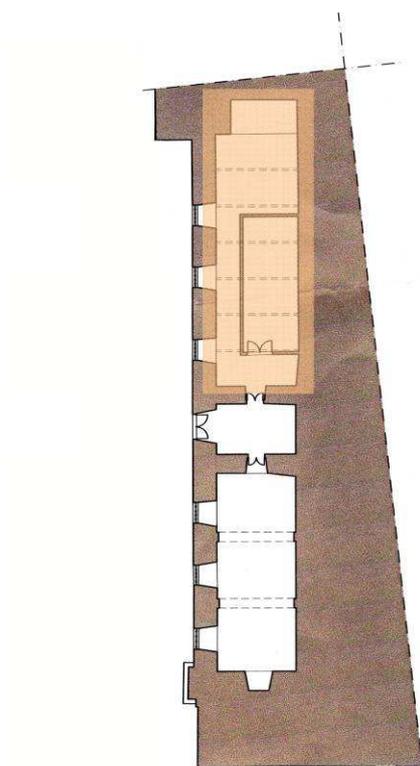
Localização da sala Nascente na planta do criptopórtico do levantamento de 2003.
